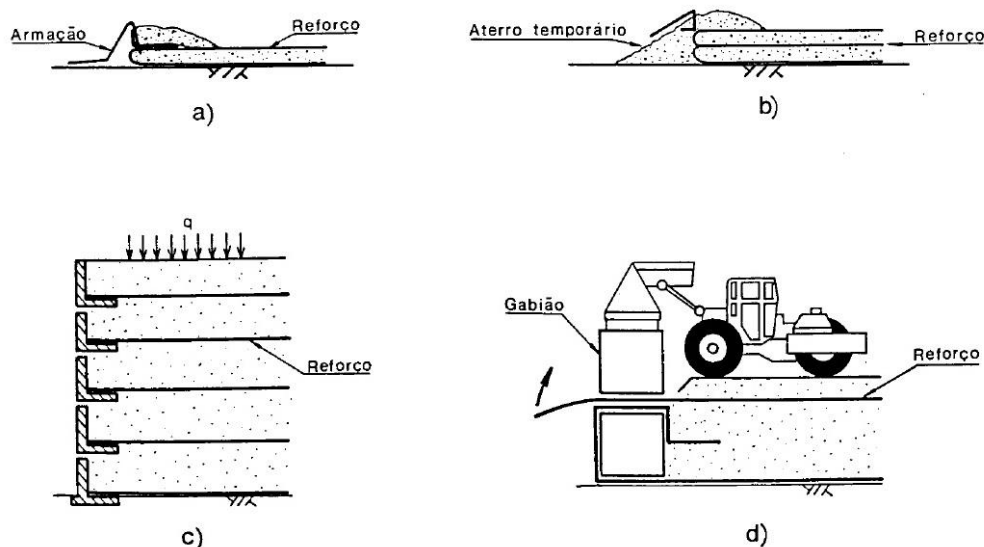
Algumas técnicas aplicadas na construção incremental de estruturas de face vertical reforçadas com geossintéticos: a) utilização de armação; b) utilização de aterro temporário; c) elementos de face em betão pré-fabricado; d) elementos de face em gabiões (Lopes, 1992).
